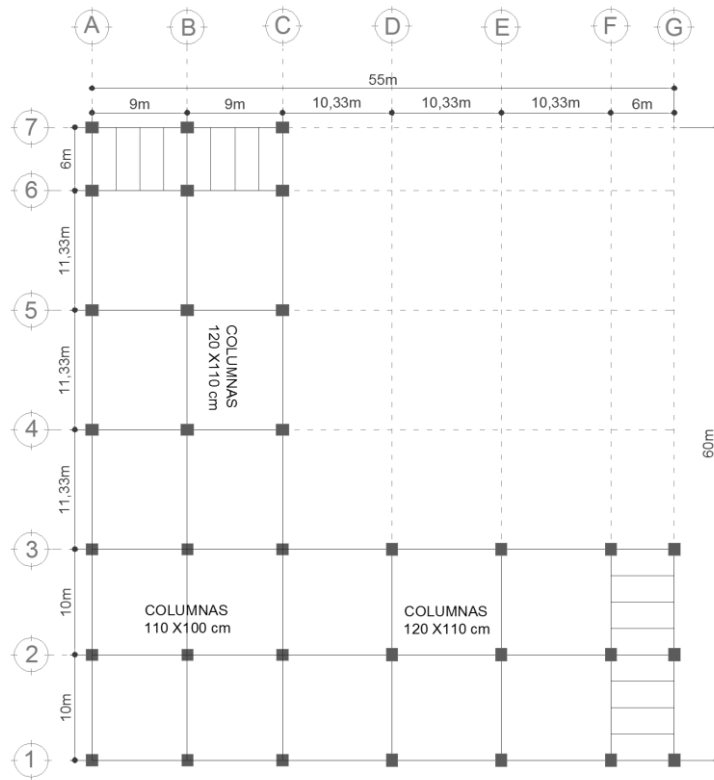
Columnas propuestas del nivel 1 al 4 para la estructura de concreto.
